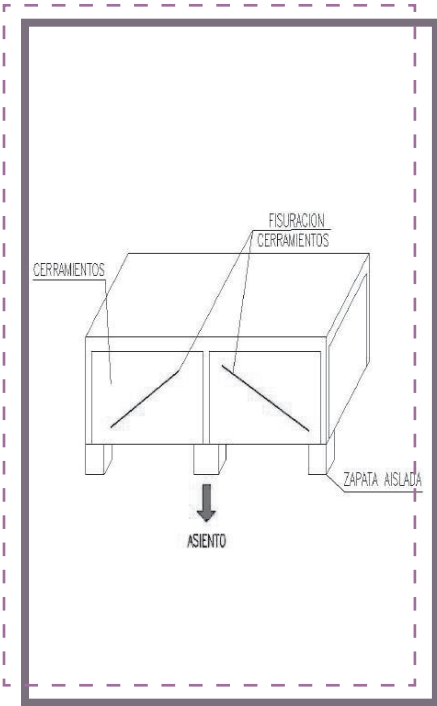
Esquema de grieta por asiento de zapata de hormigón armado de un pilar.
